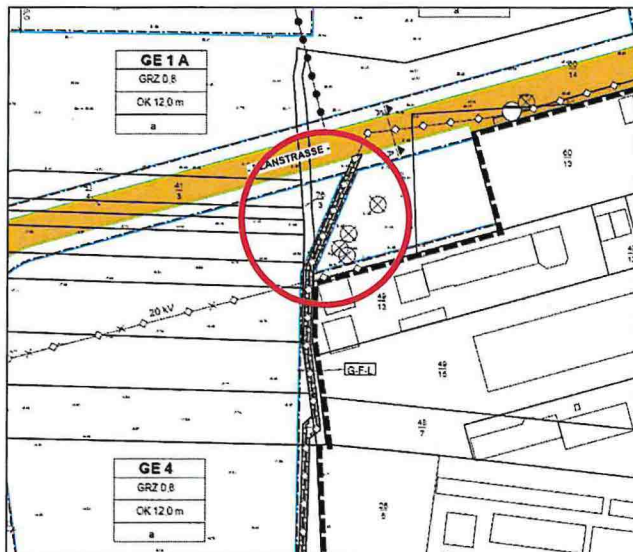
Auszug verbindlicher Bauungsplan Nr. 41 „Vietingshof Nord“, Datum: 14.10.2024
